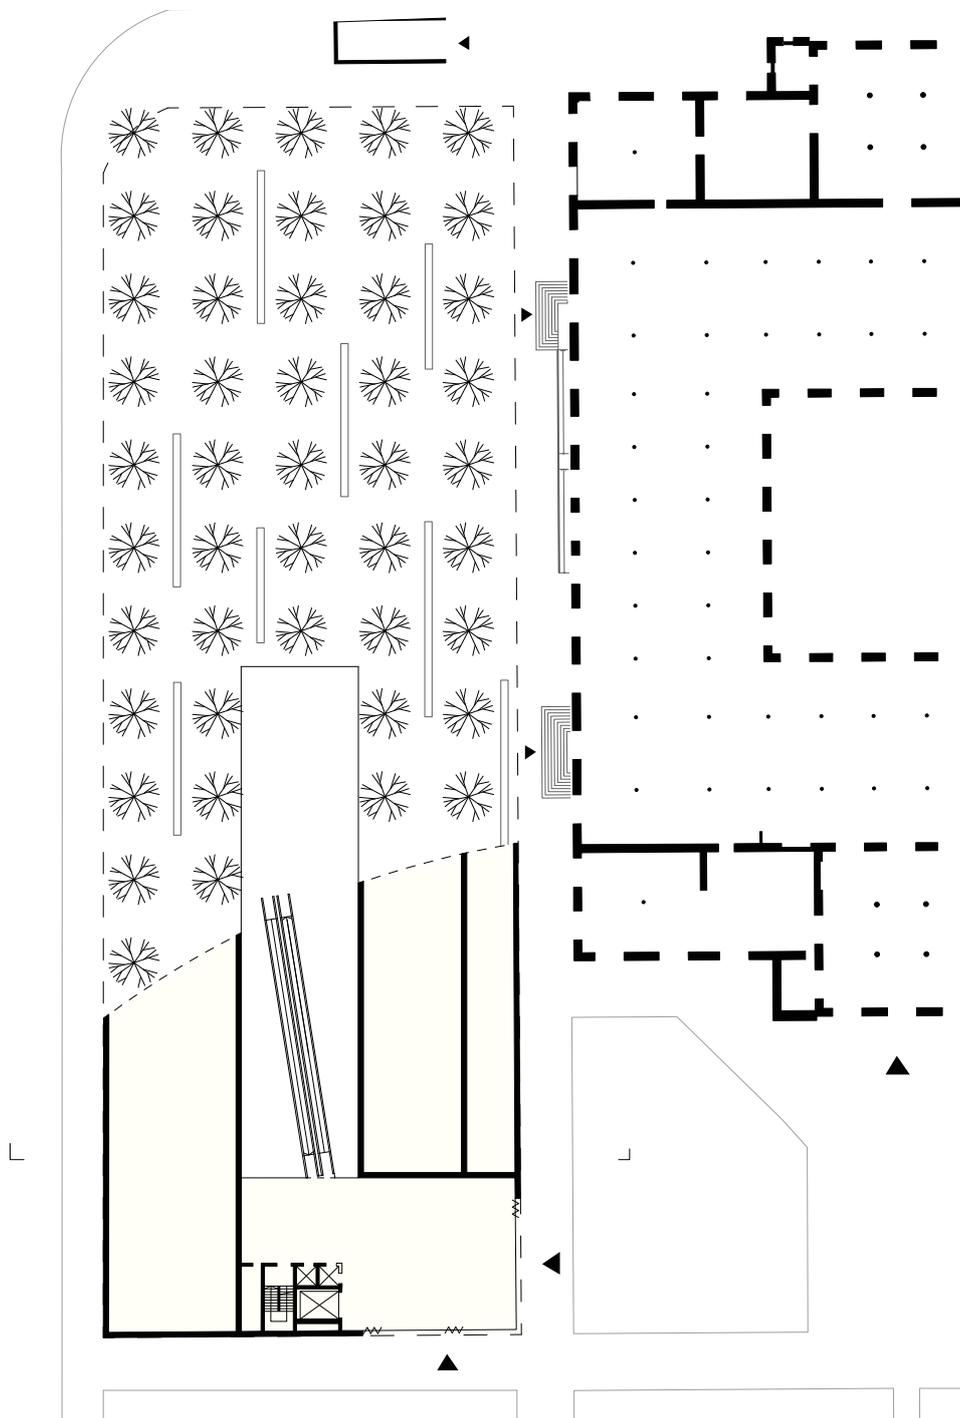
Wettbewerbsbeitrag Grundriss Erdgeschoß
